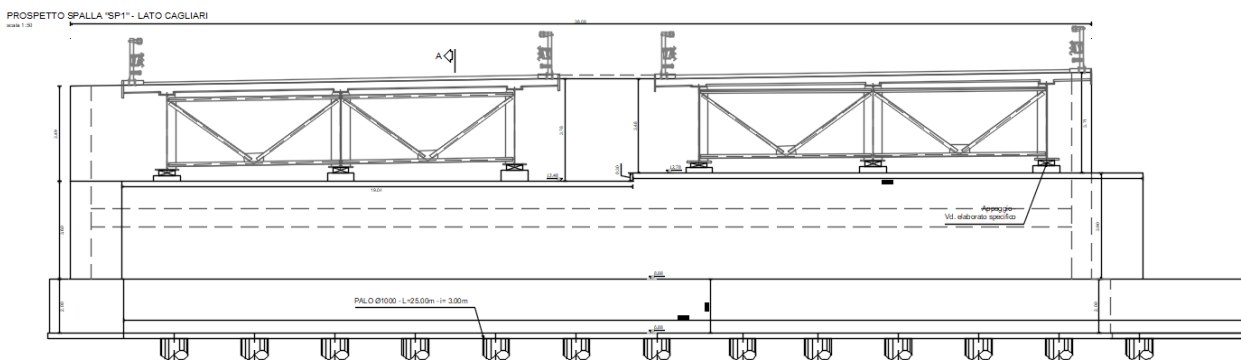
Prospetto spalla lato Cagliari
